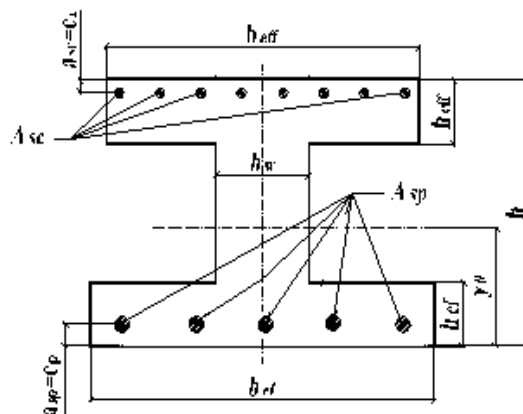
Схема розташування арматури в перерізі плити
